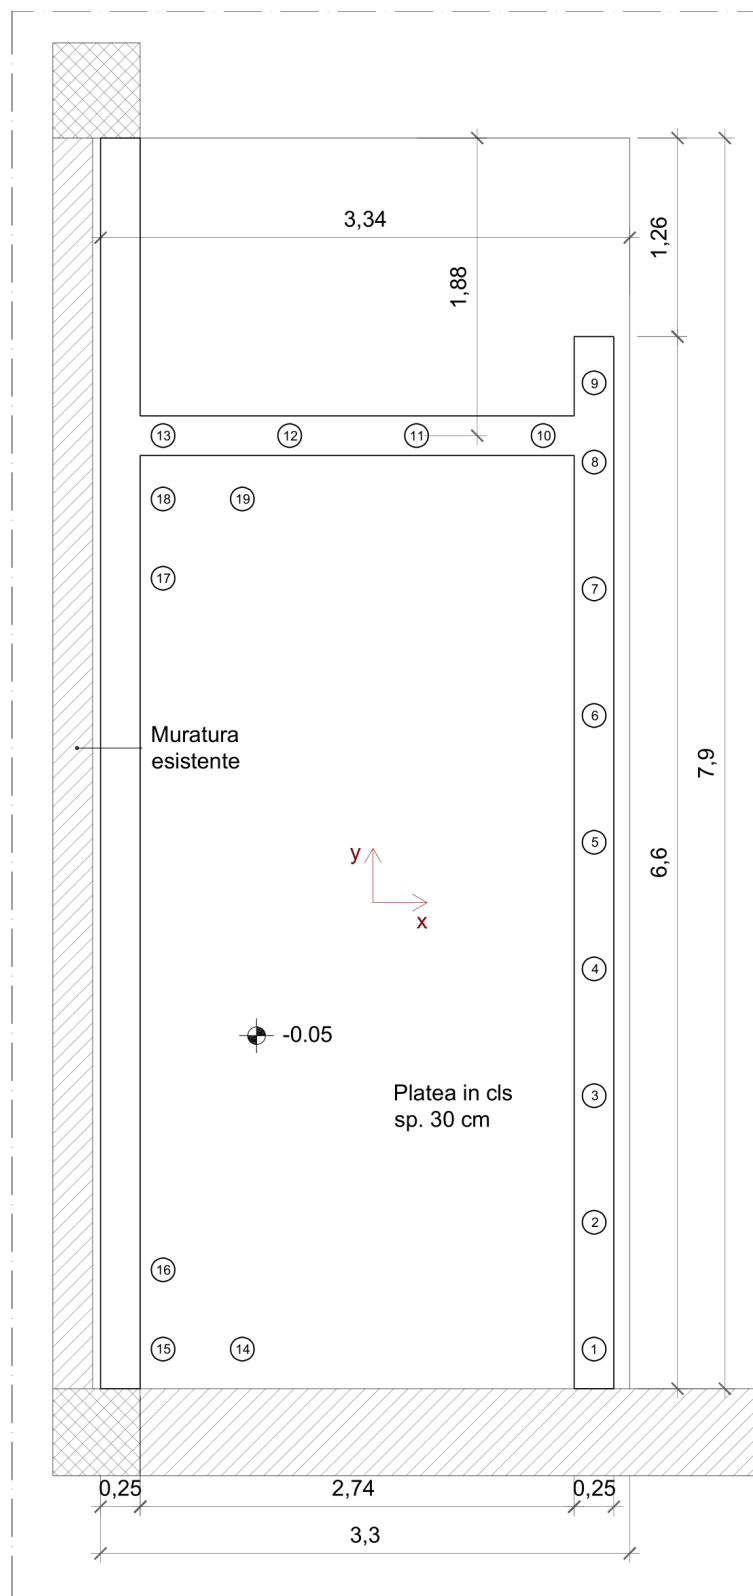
Disposizione planimetrica dei micropali - scala B.
